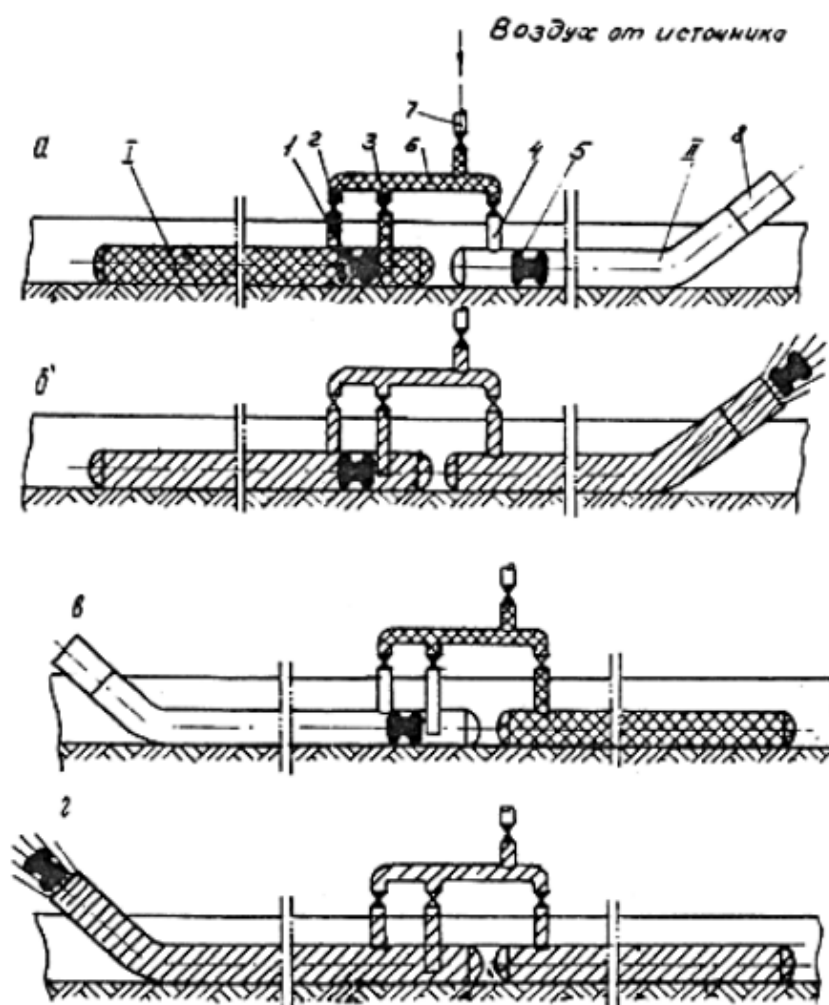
Принципиальная схема продувки трубопроводов воздухом:
